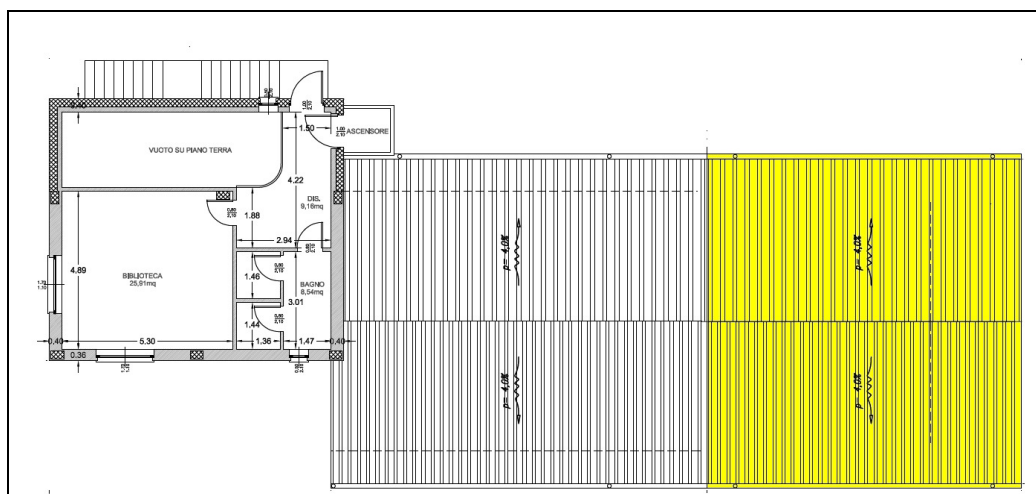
Progetto: pianta del piano primo (tratta dalla Tavola n. 5)
